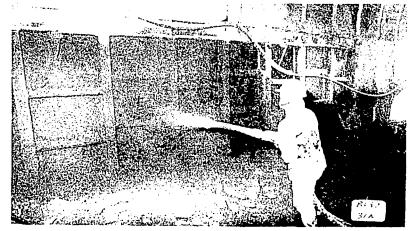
Fotografía de colocación de concreto lanzado en zona de marcos de la media sección inferior del túnel
